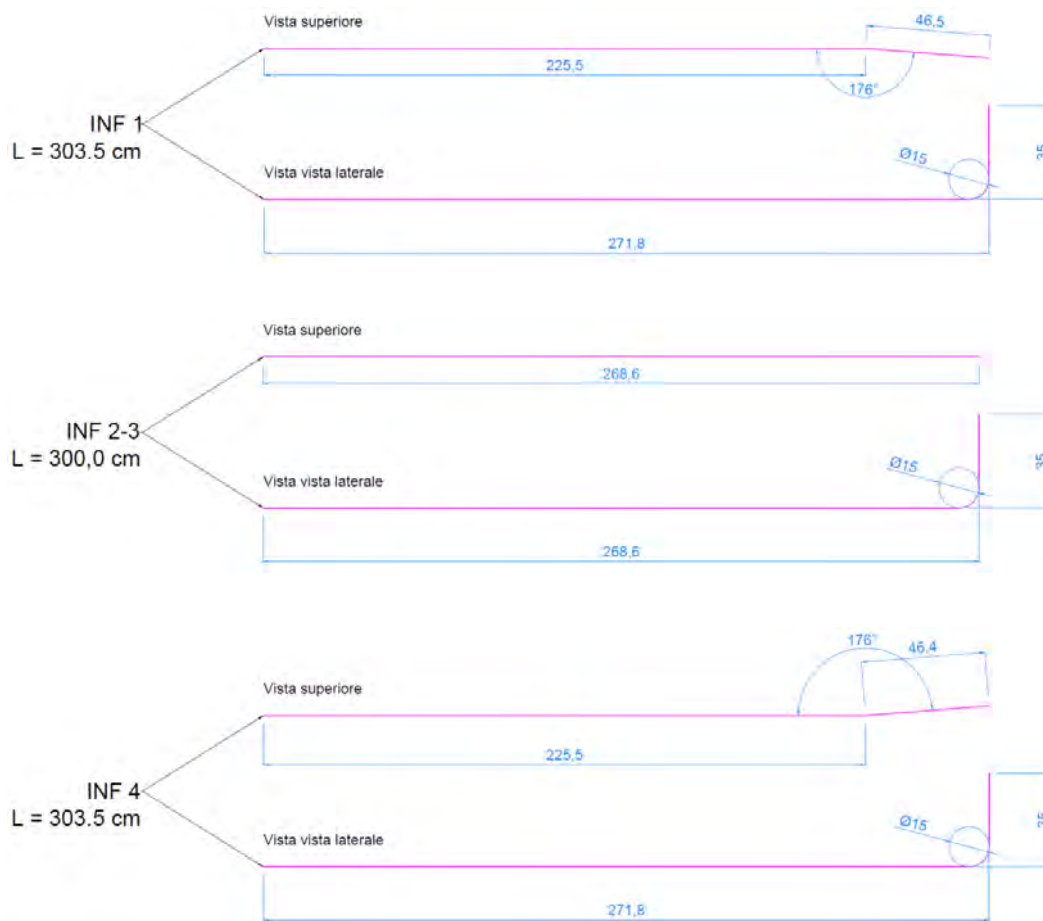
Particolare armatura longitudinale inferiore trave.
